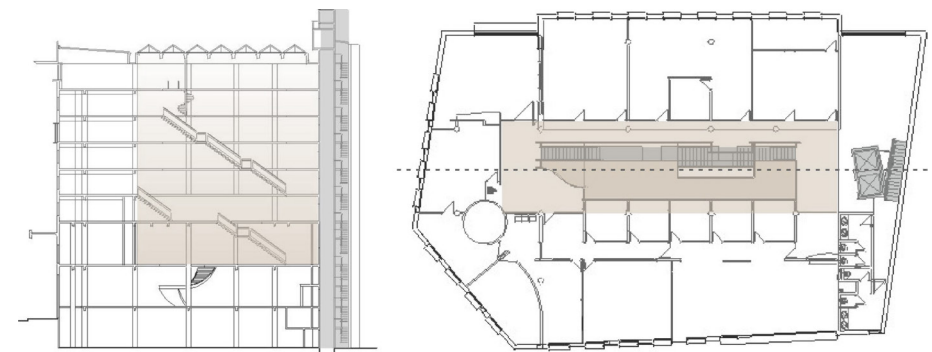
| Corte longitudinal y plantas tipo de la intervención.
